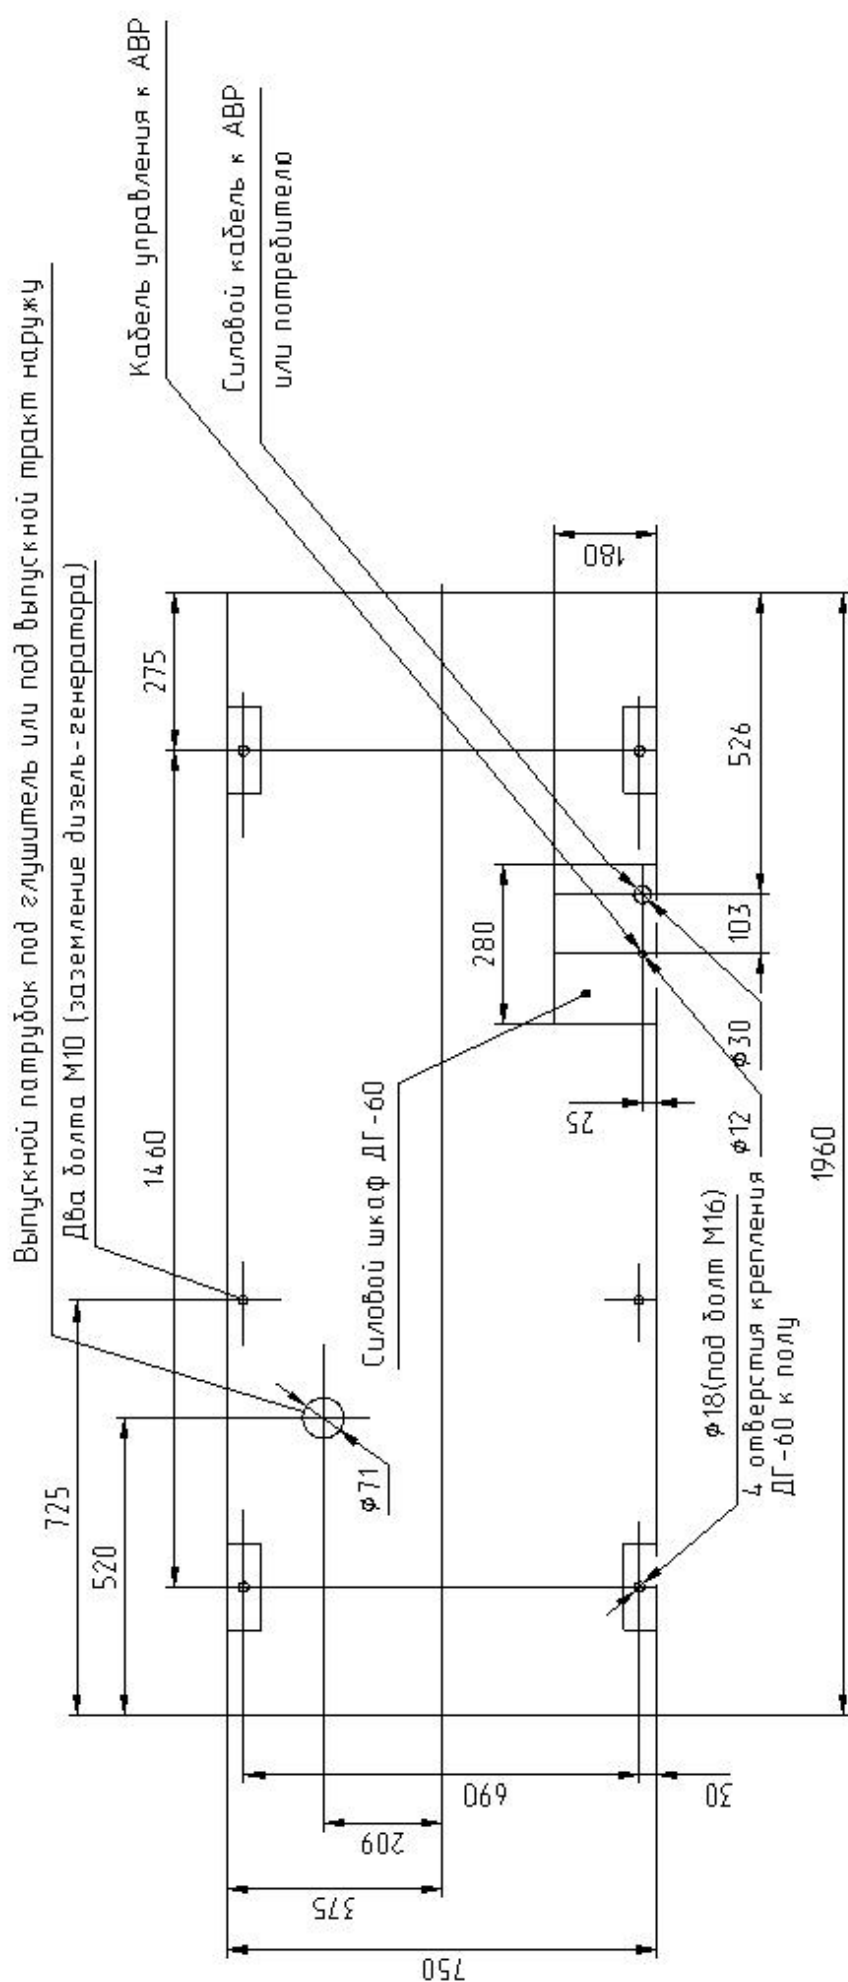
Монтажный чертеж установки ДГ-60 (вид сверху).
